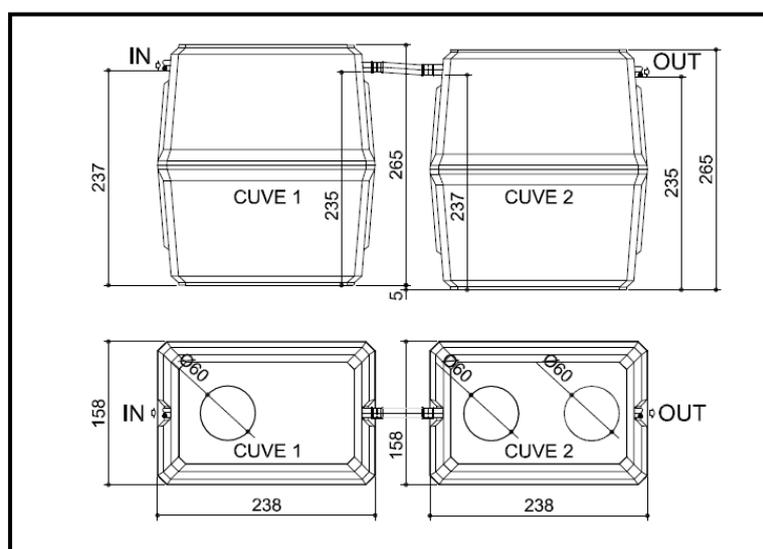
Plan d'encombrement des Oxyfix® C-90 MB 17 EH
